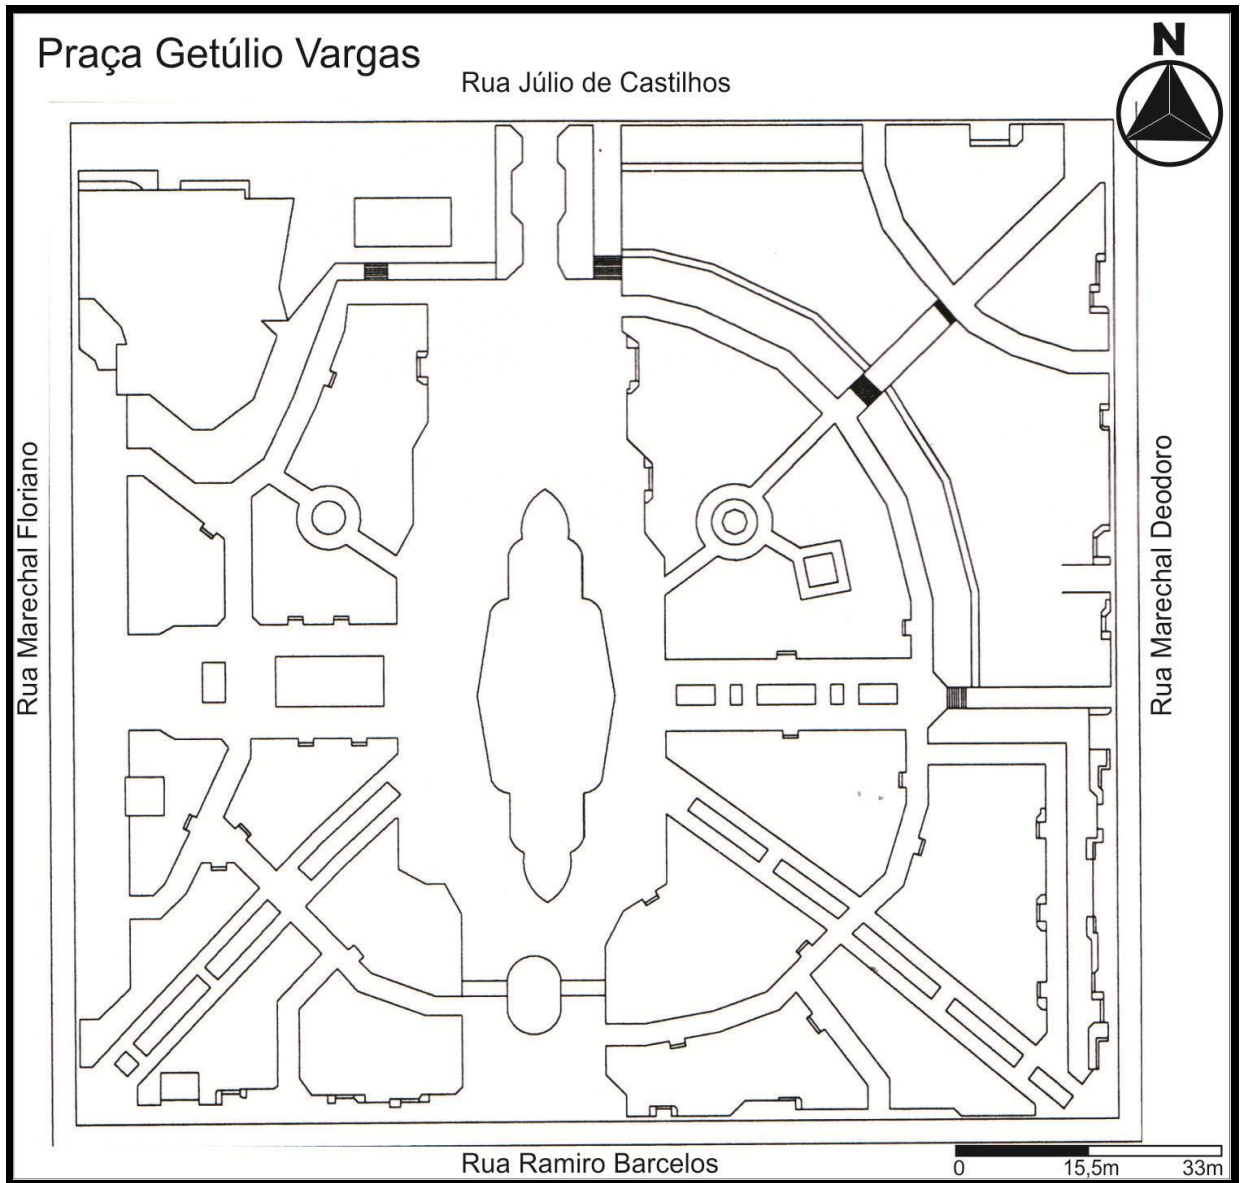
Planta da Praça Getúlio Vargas, 2003.
